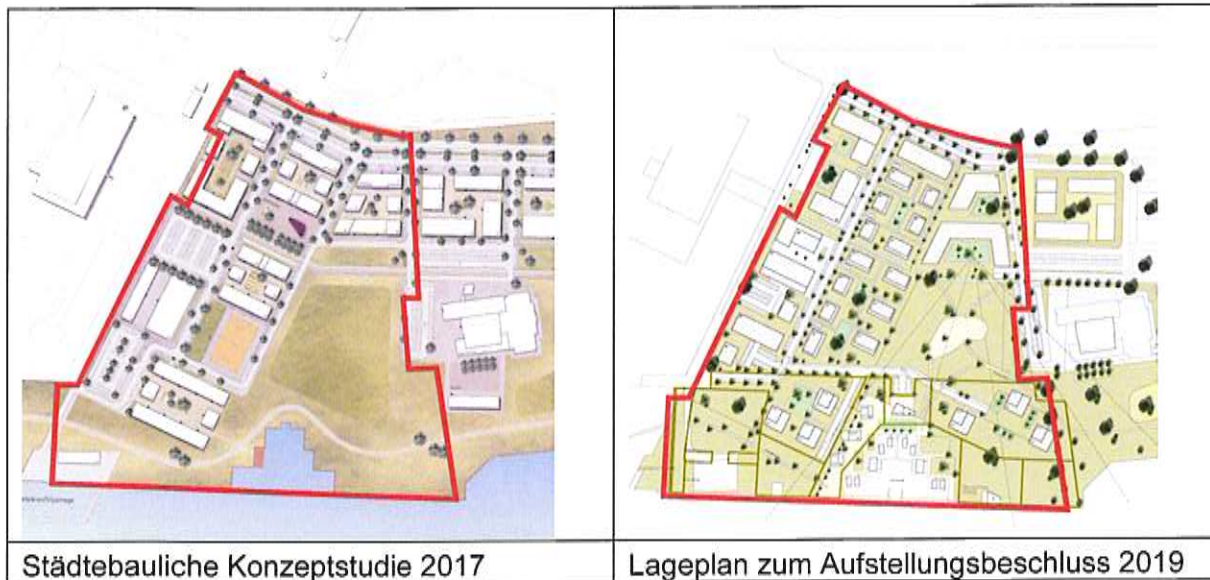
Planungsvarianten Konzeptstudie 2017 und Lageplan Aufstellungsbeschluss 2019
